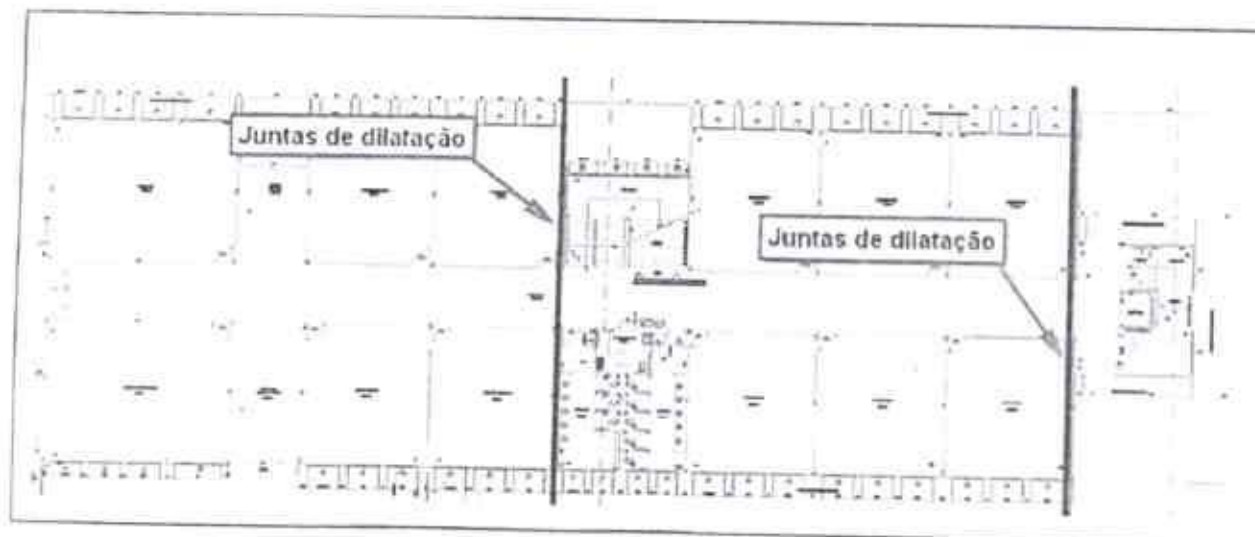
Planta baixa do pavimento térreo com a posição das juntas de dilatação
